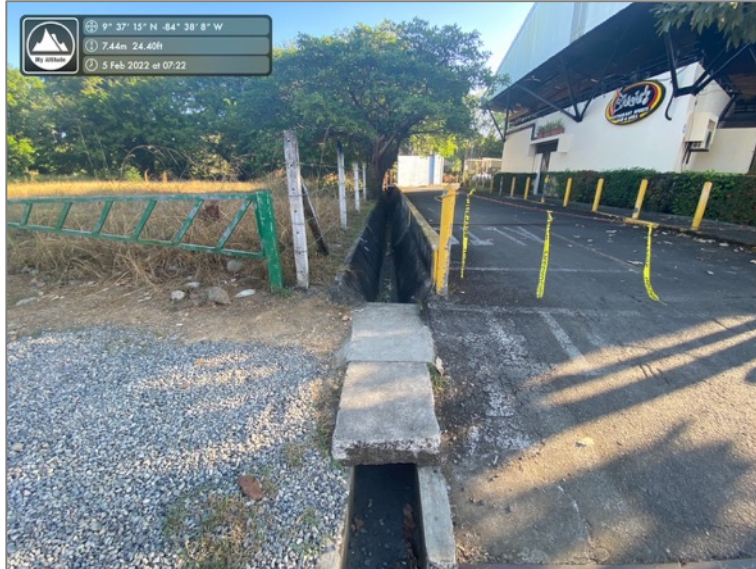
Desfogue de alcantarillado pluvial (cuneta paralela a Calle Bulevar Jacó) a la Quebrada Doña María
